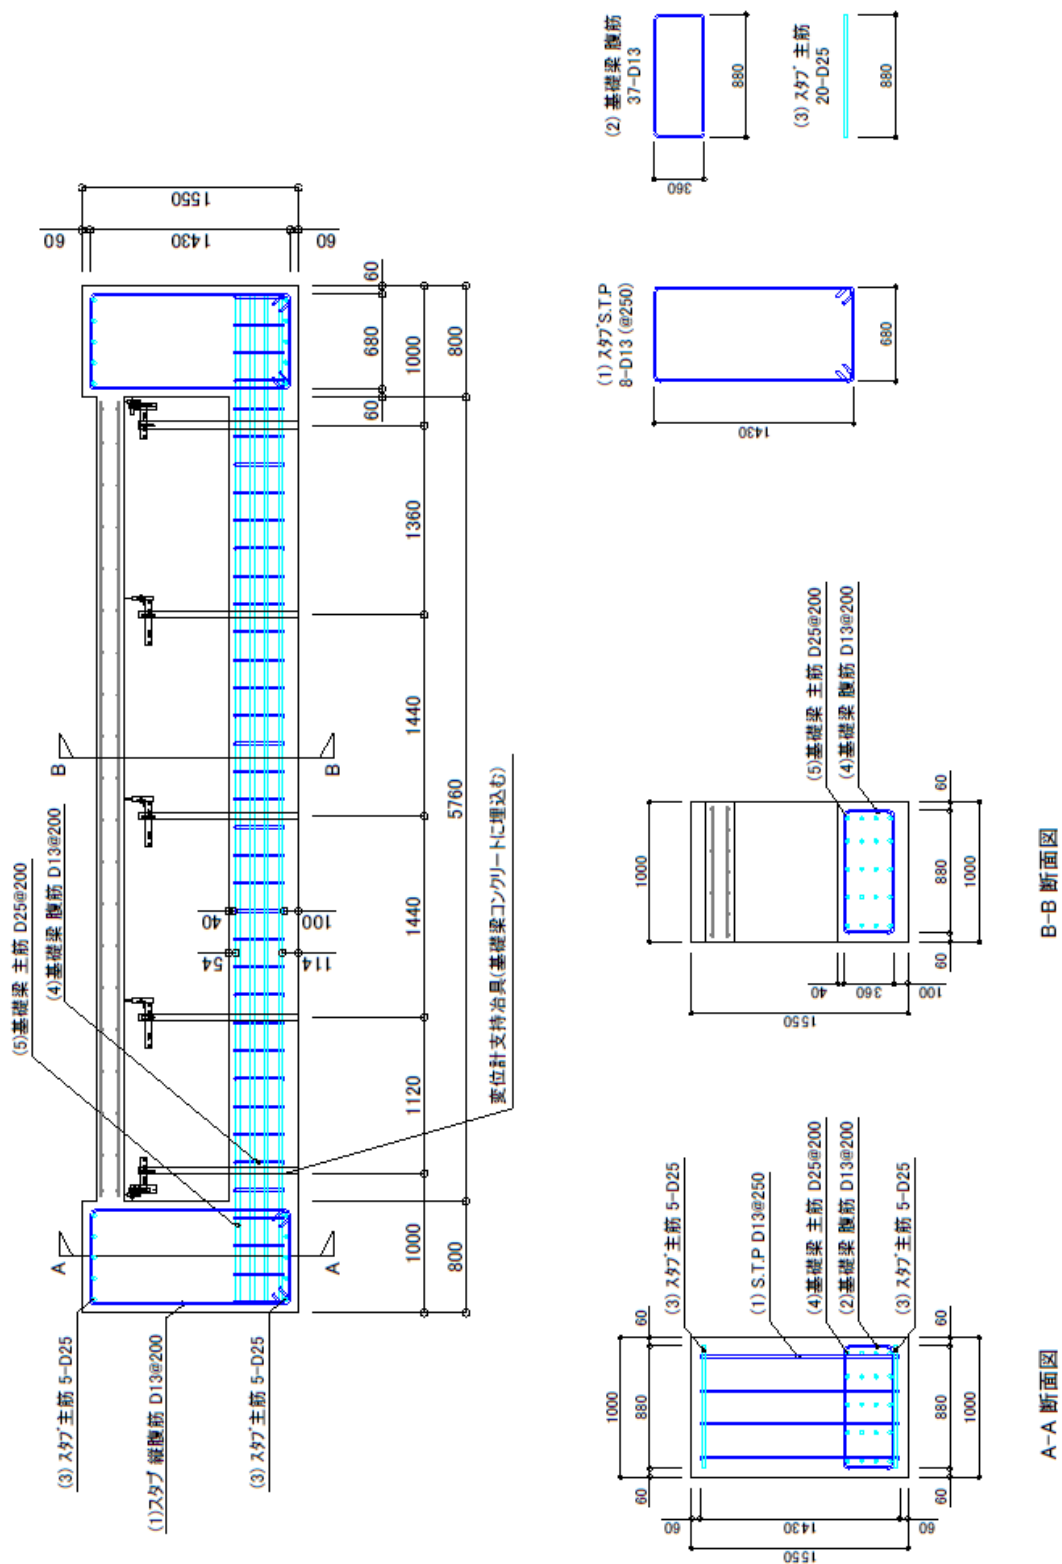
基礎梁・スタブ配筋図(AH, BA, AC 試験体)
